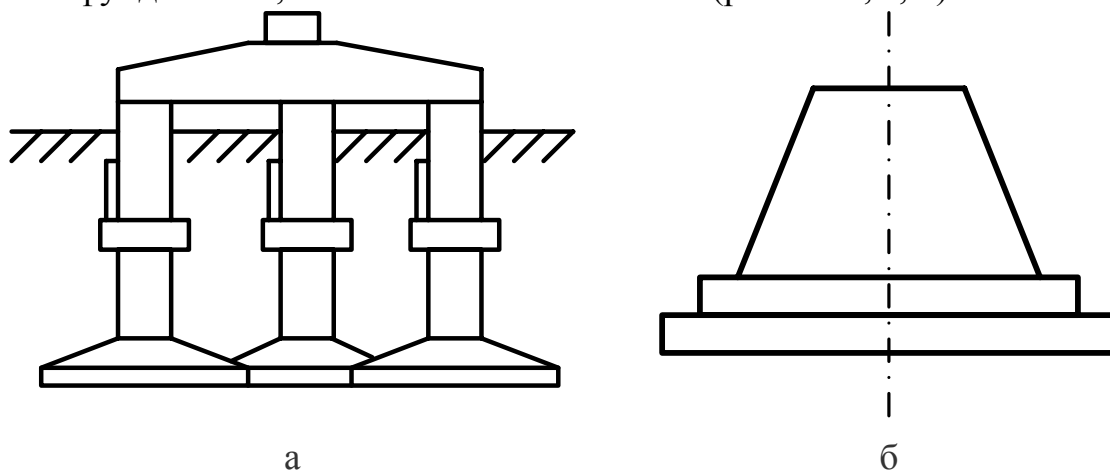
Фундаменты переходных опор: а – железобетонный сборный фундамент; б – бетонный монолит
